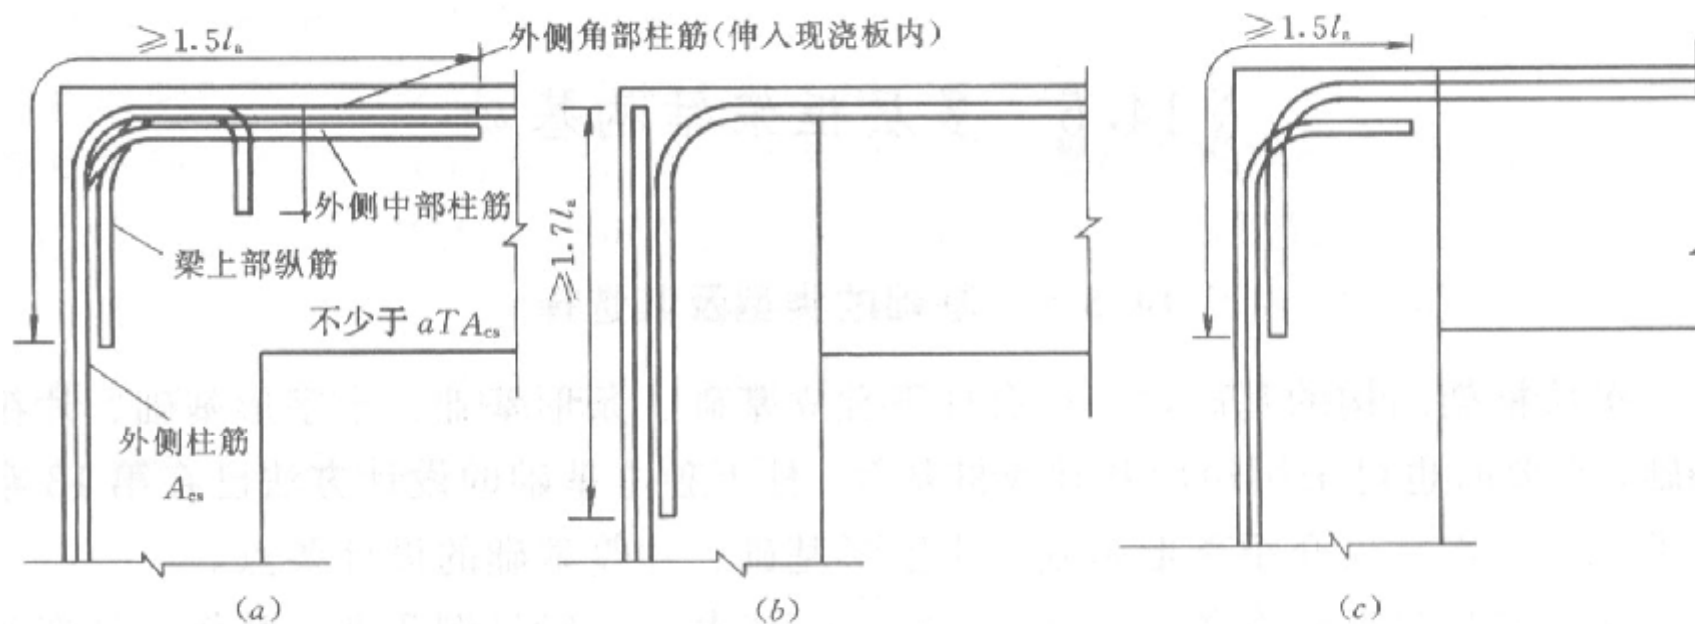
梁上部纵向钢筋与柱外侧纵向钢筋在顶层端节点的搭接
